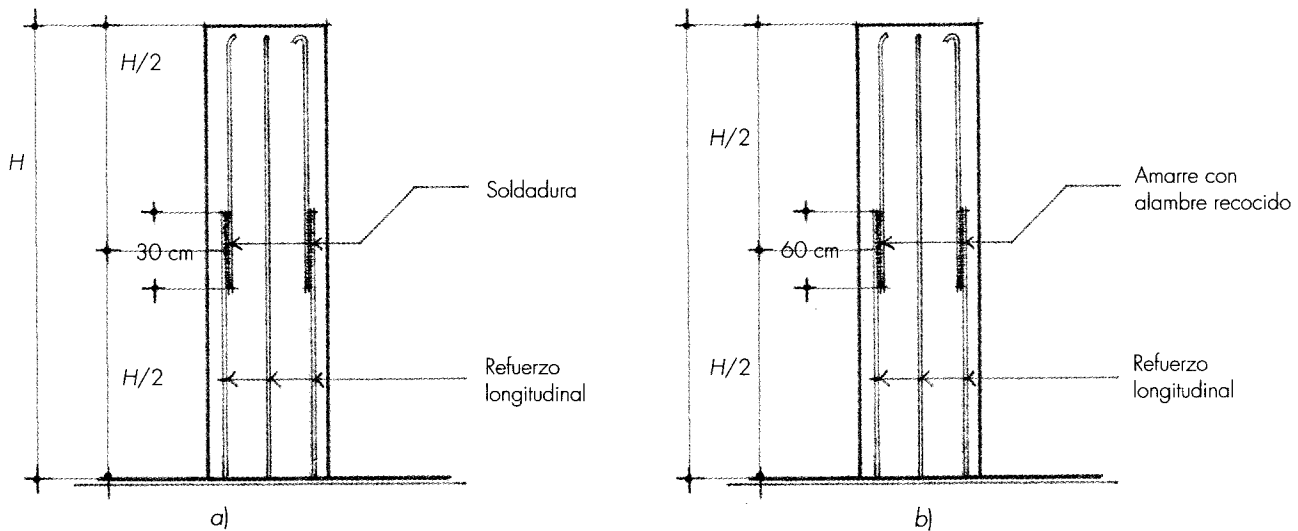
a) Varillas soldadas con 30 cm de traslape. b) Varillas amarradas con 60 cm de traslape.
